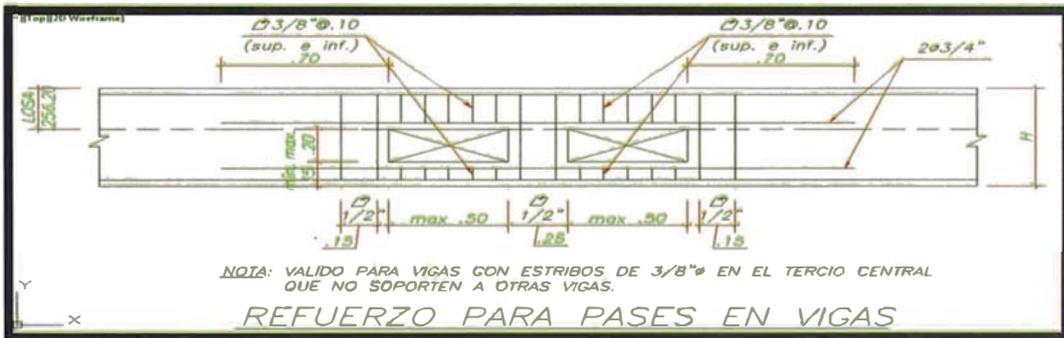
Refuerzo por pase de bandeja en viga- ubicado al tercio central.
